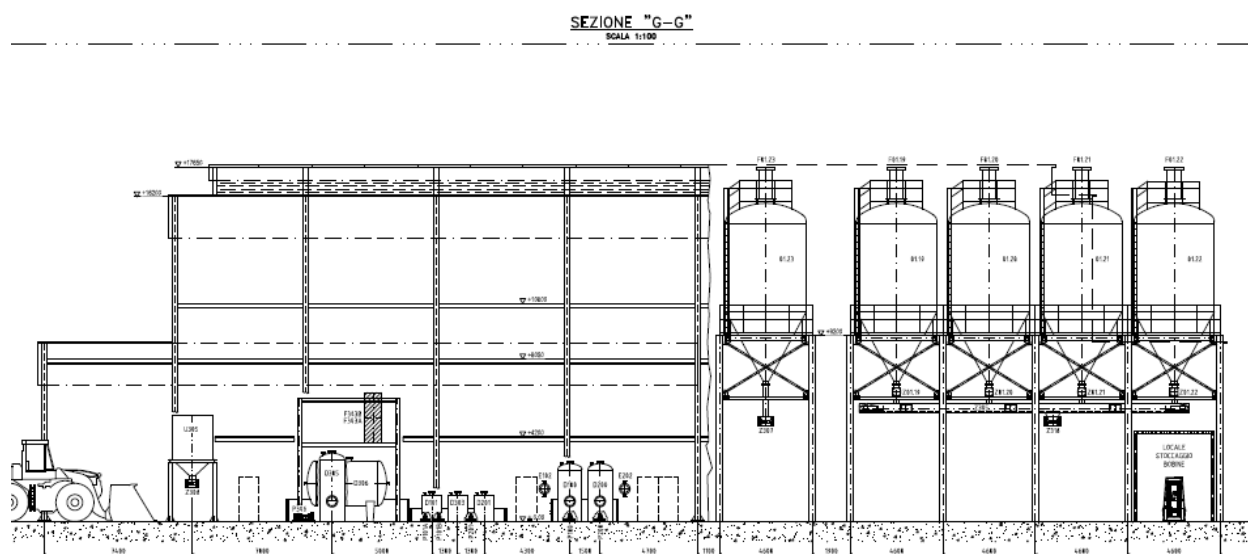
Progetto definitivo delle opere (sezione “G-G”)
